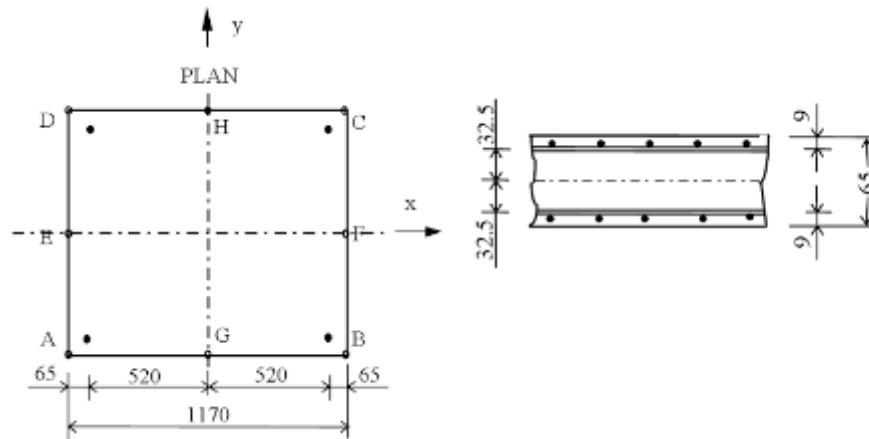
Dimensões (em mm) e armaduras da laje do Exemplo 3
